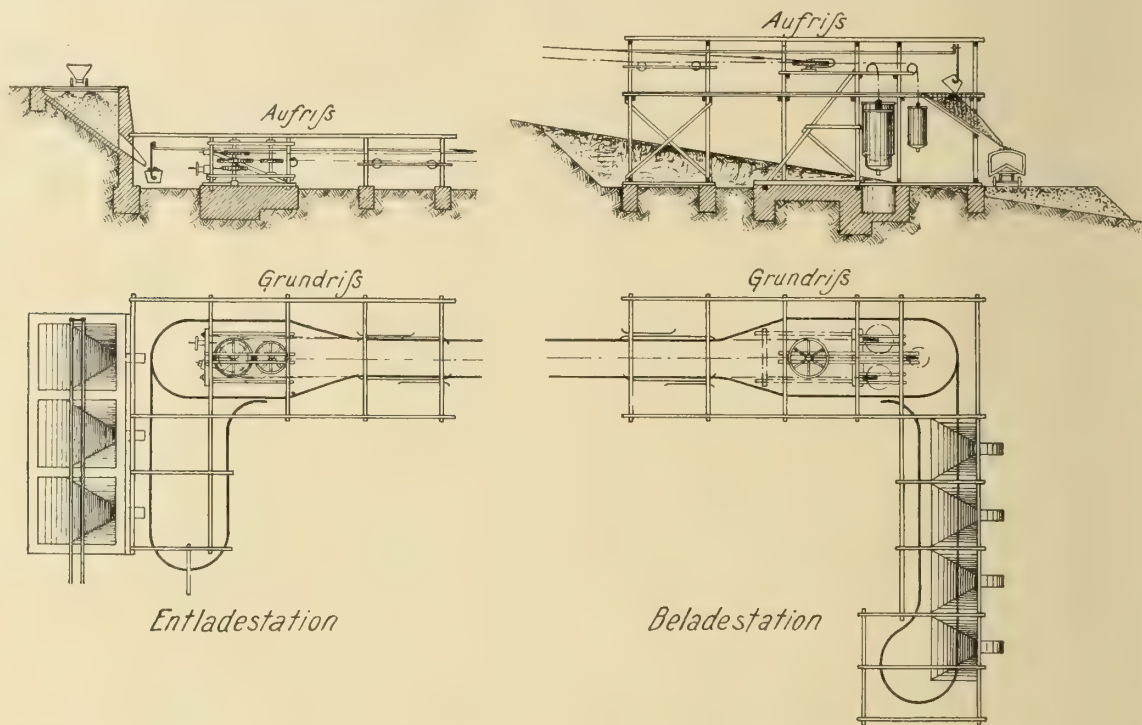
Belade- und Entladeeinrichtung einer Drahtseilbahn mit anschließendem Kraftwagentransport.
